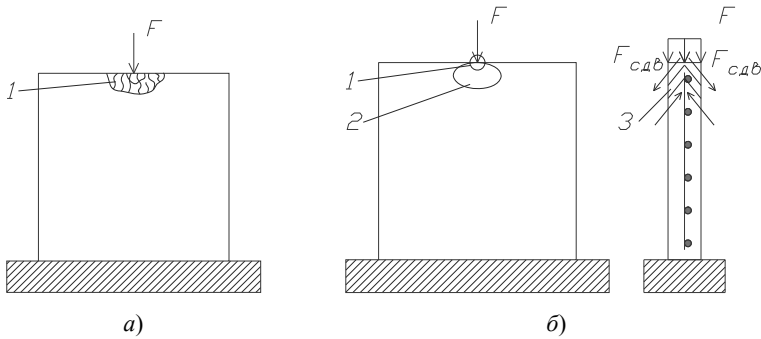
Испытание модели стены, армированной арматурной сеткой, под действием сосредоточенной нагрузки:
